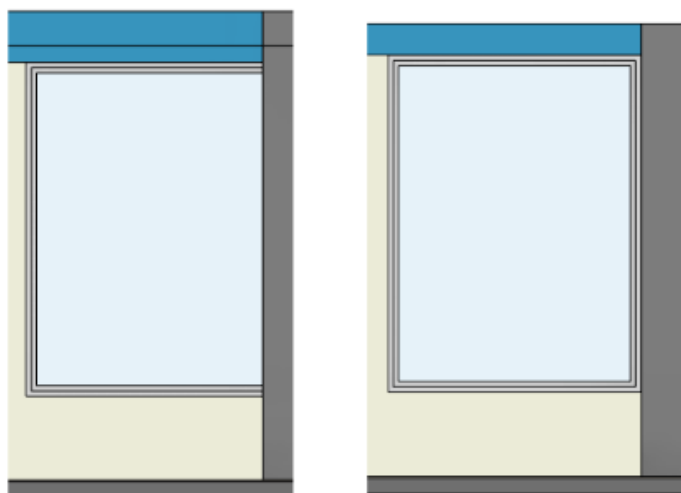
Conflito Janela x pilar (Pavimento 2)
